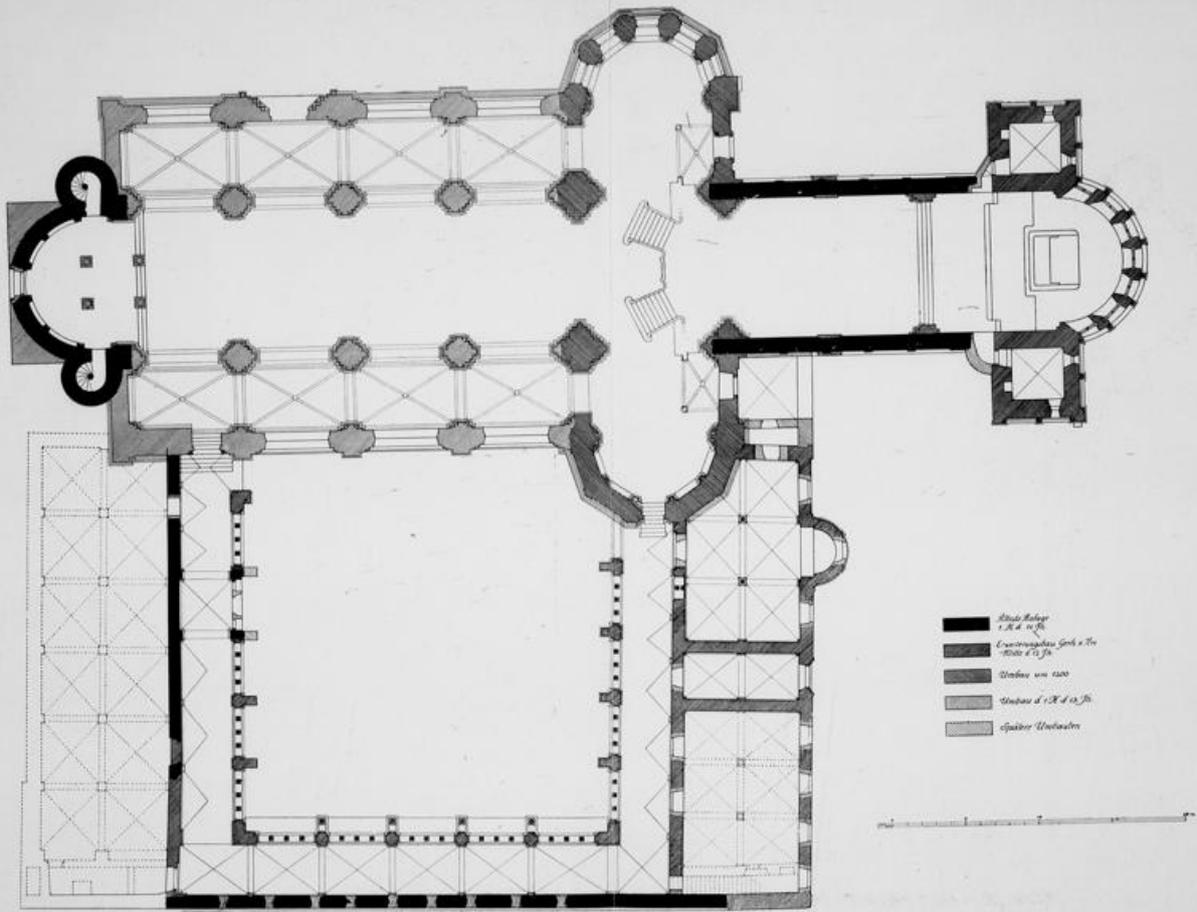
Bonn. Münster. Grundriss des oberen Kreuzganggeschosses (1:300).
